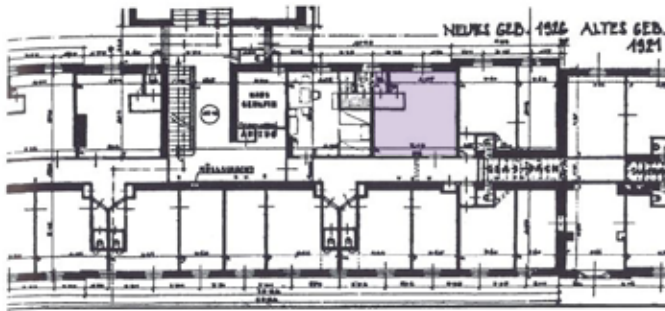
Regelgeschoß Einküchenhaus, M 1:500
